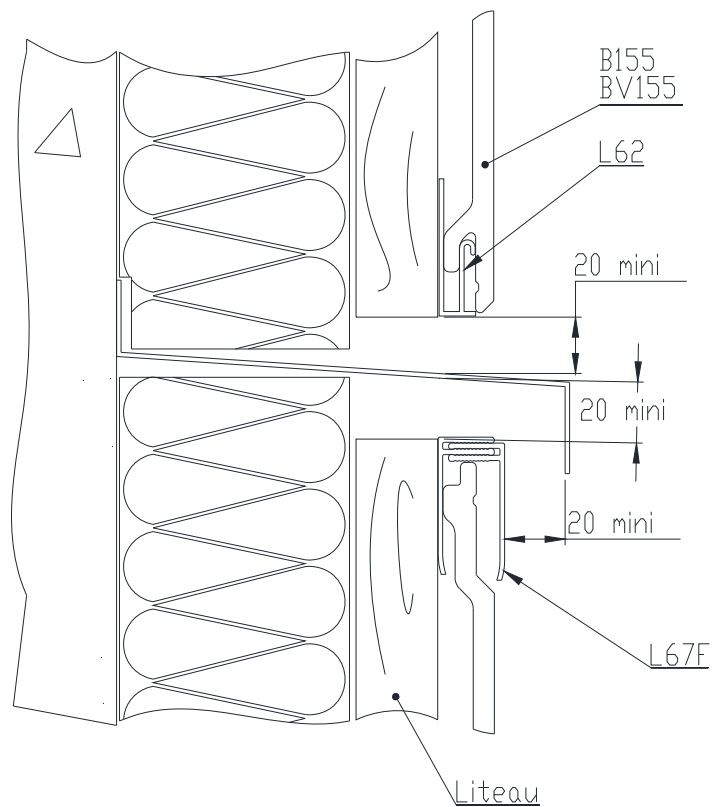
Coupe de mise en œuvre sur construction à ossature bois
